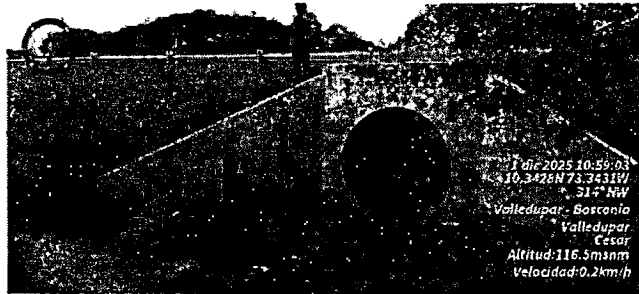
Alcantarilla de 2.1 m de diámetro. SC
